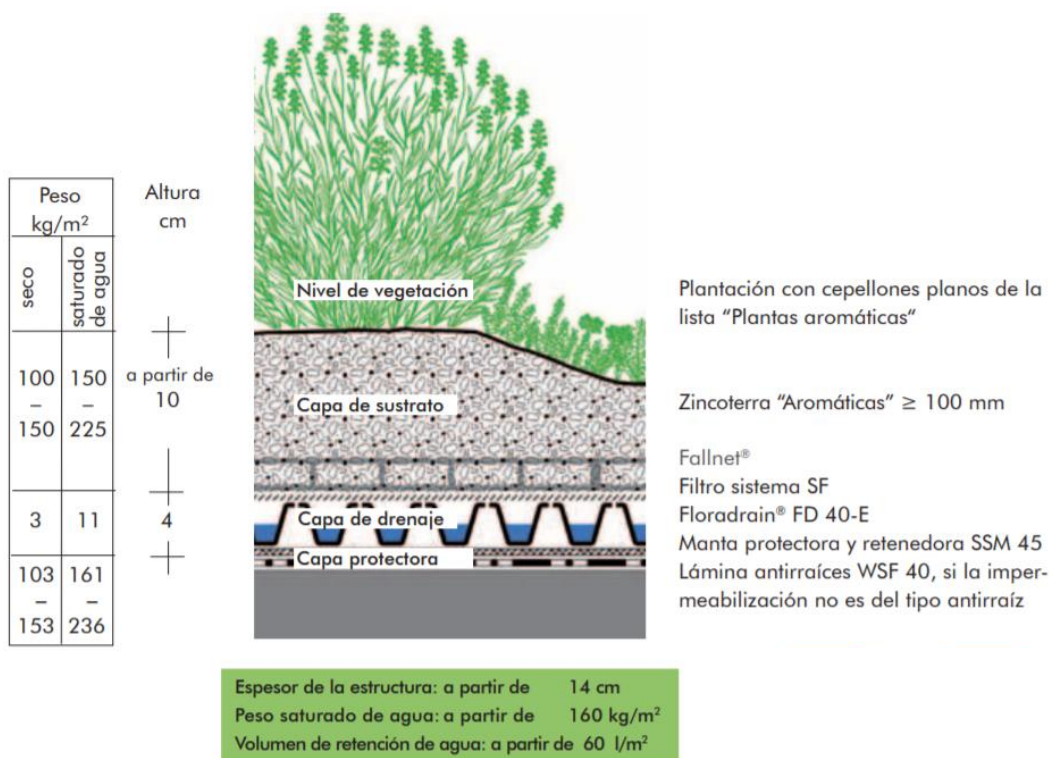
Secció constructiva sistema "Plantas aromáticas".
